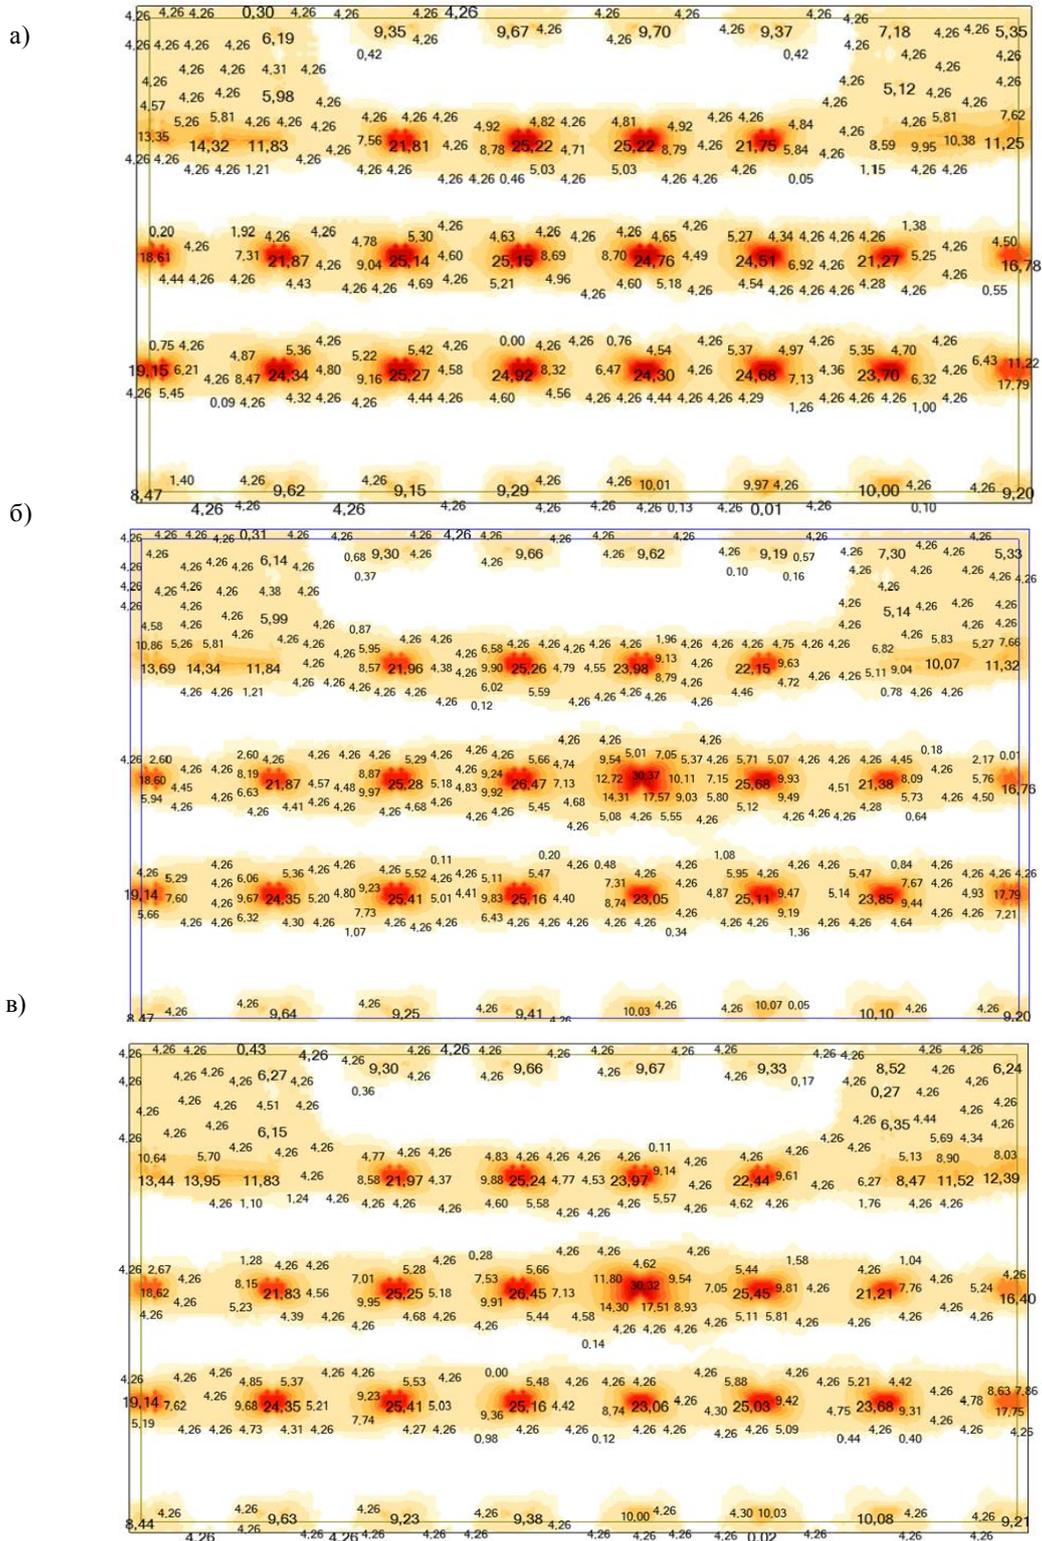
Площадь арматуры в фундаментной плите (нижняя по оси Y, ось Y ориентирована вертикально) на этапе 1 (а) этапе 2 (б) и этапе 3 (в)
